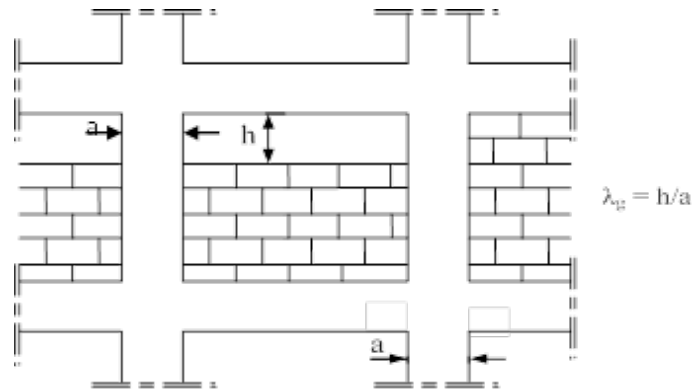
Cas de constitution de poteau court, par hauteur insuffisante de la maçonnerie de remplissage
